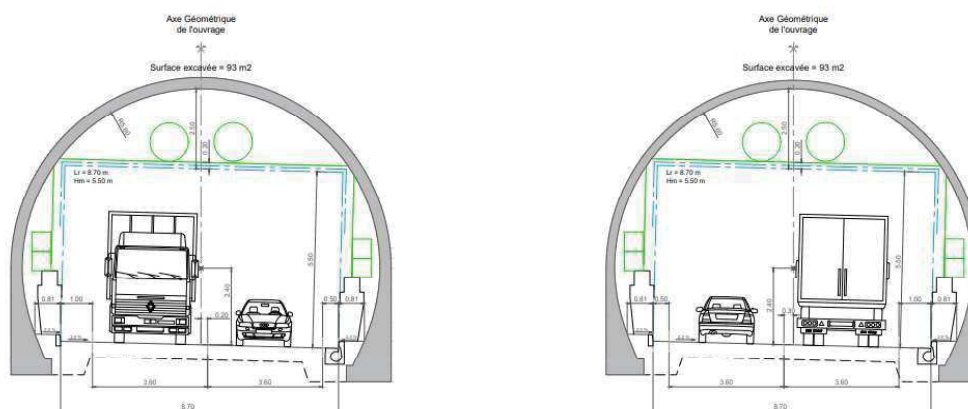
Sección transversal – Túnel (ancho útil: 8,70m)
